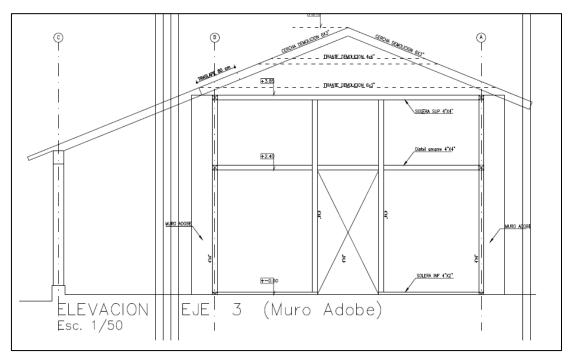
Modelo tipo de la vivienda nueva construida. Fuente: Proyecto reconstrucción EGIS PLANING S.A.
